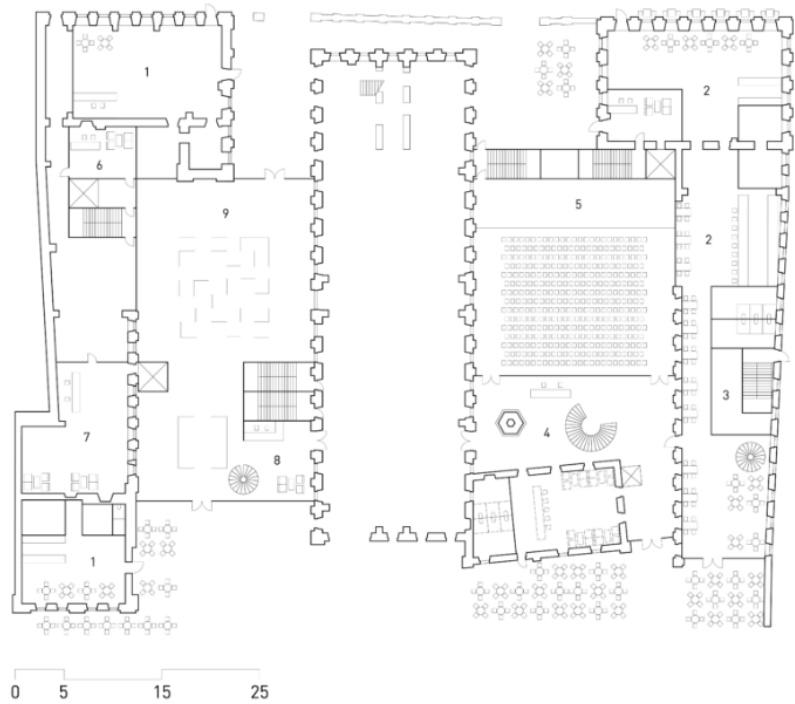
План першого поверху з експлікацією проєкту будівлі Szukerka.[19]
